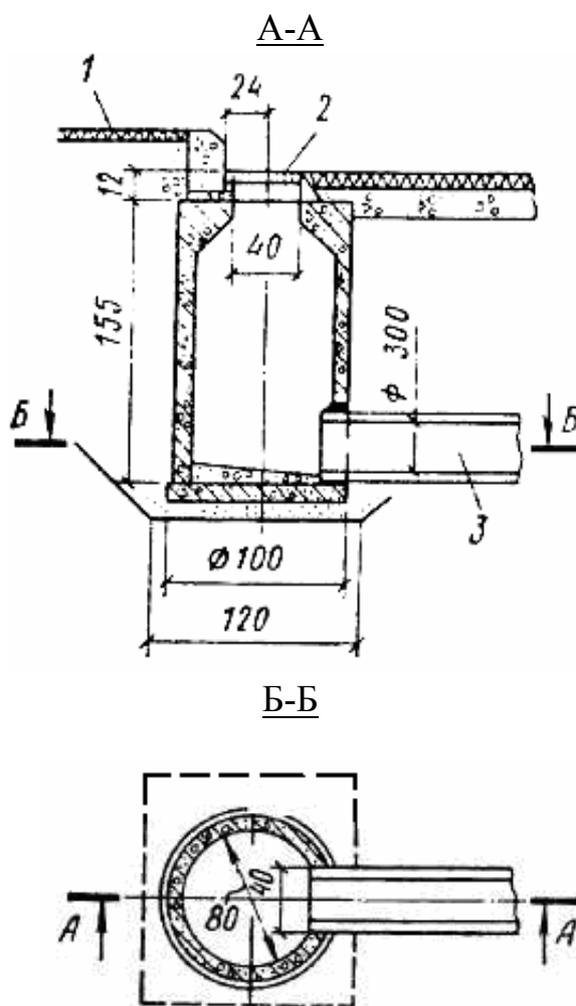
Железобетонный дождеприемник: 1 – тротуар; 2 – решетка; 3 – соединительная ветка
